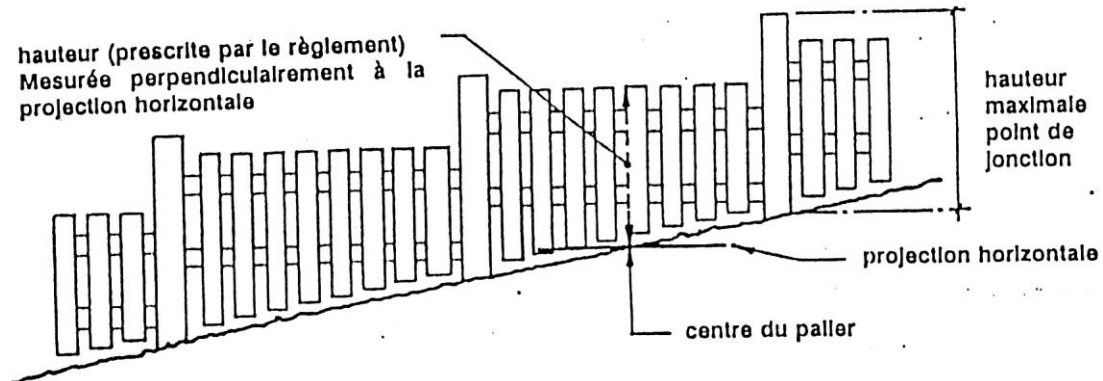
Hauteur d'une clôture sur un terrain en pente
